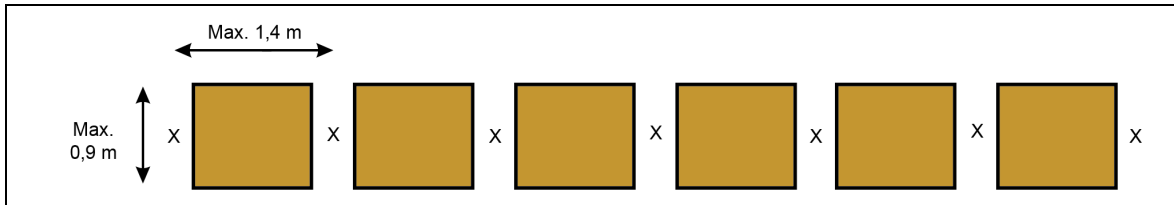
Vue en plan de l'agencement alternatif des sprinkleurs dans des casiers simples mesurant jusqu'à 0,9 m de profondeur
